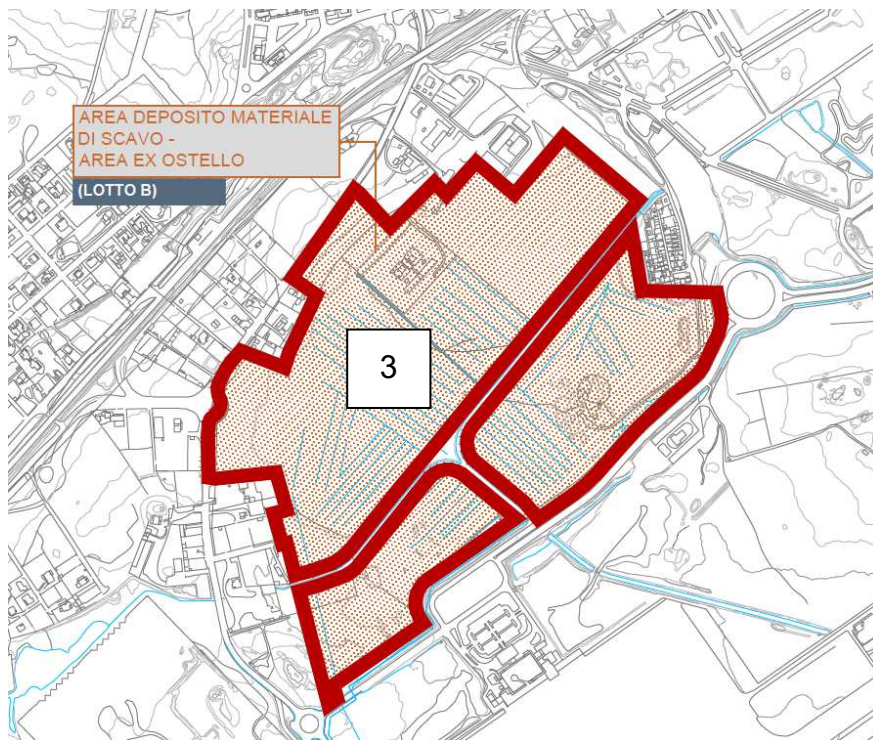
Porzione 3 del cantiere B) di Colcò
